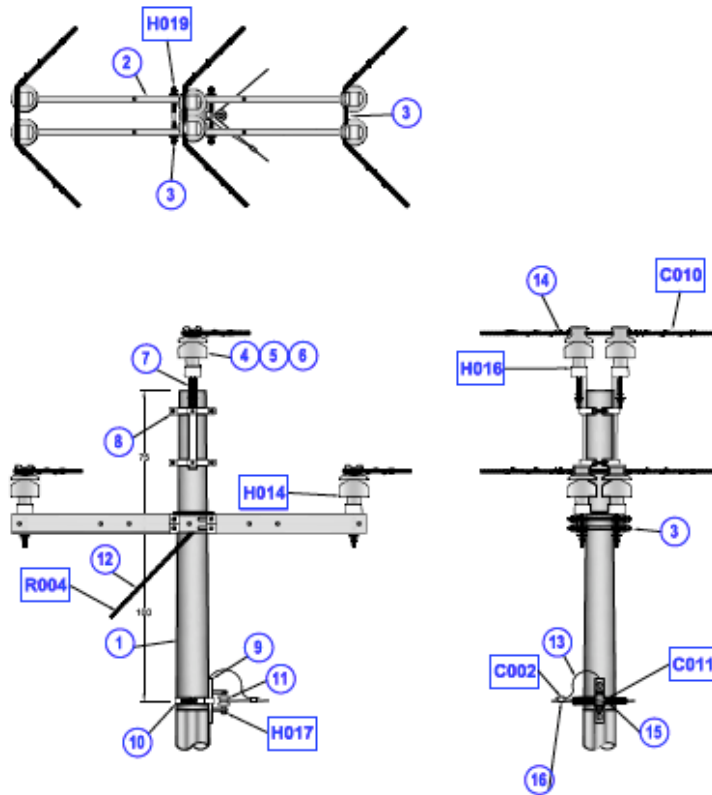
Tipo de estructuras de soporte para Línea de distribución.
